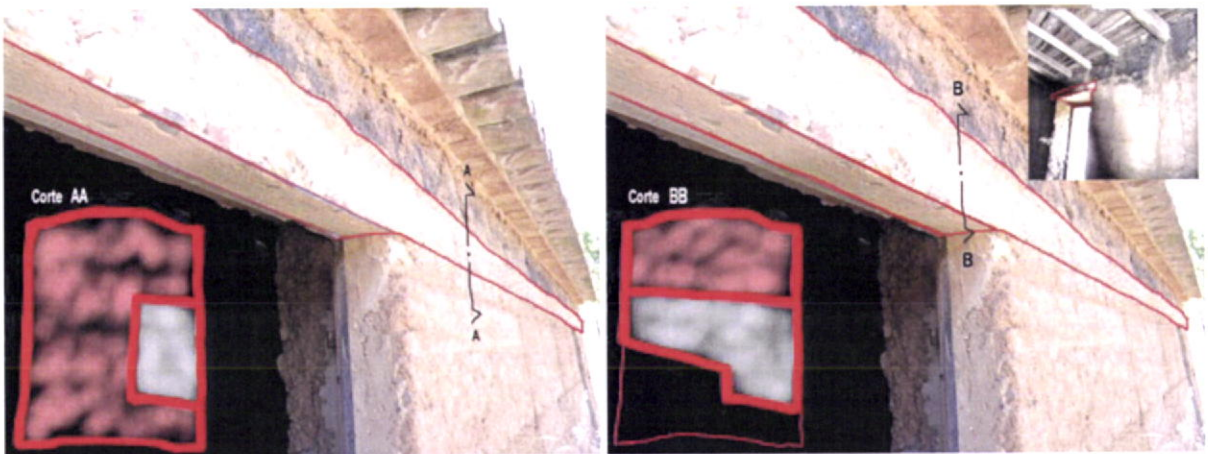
Corte da viga em zona de parede e em zona de vão de porta.
